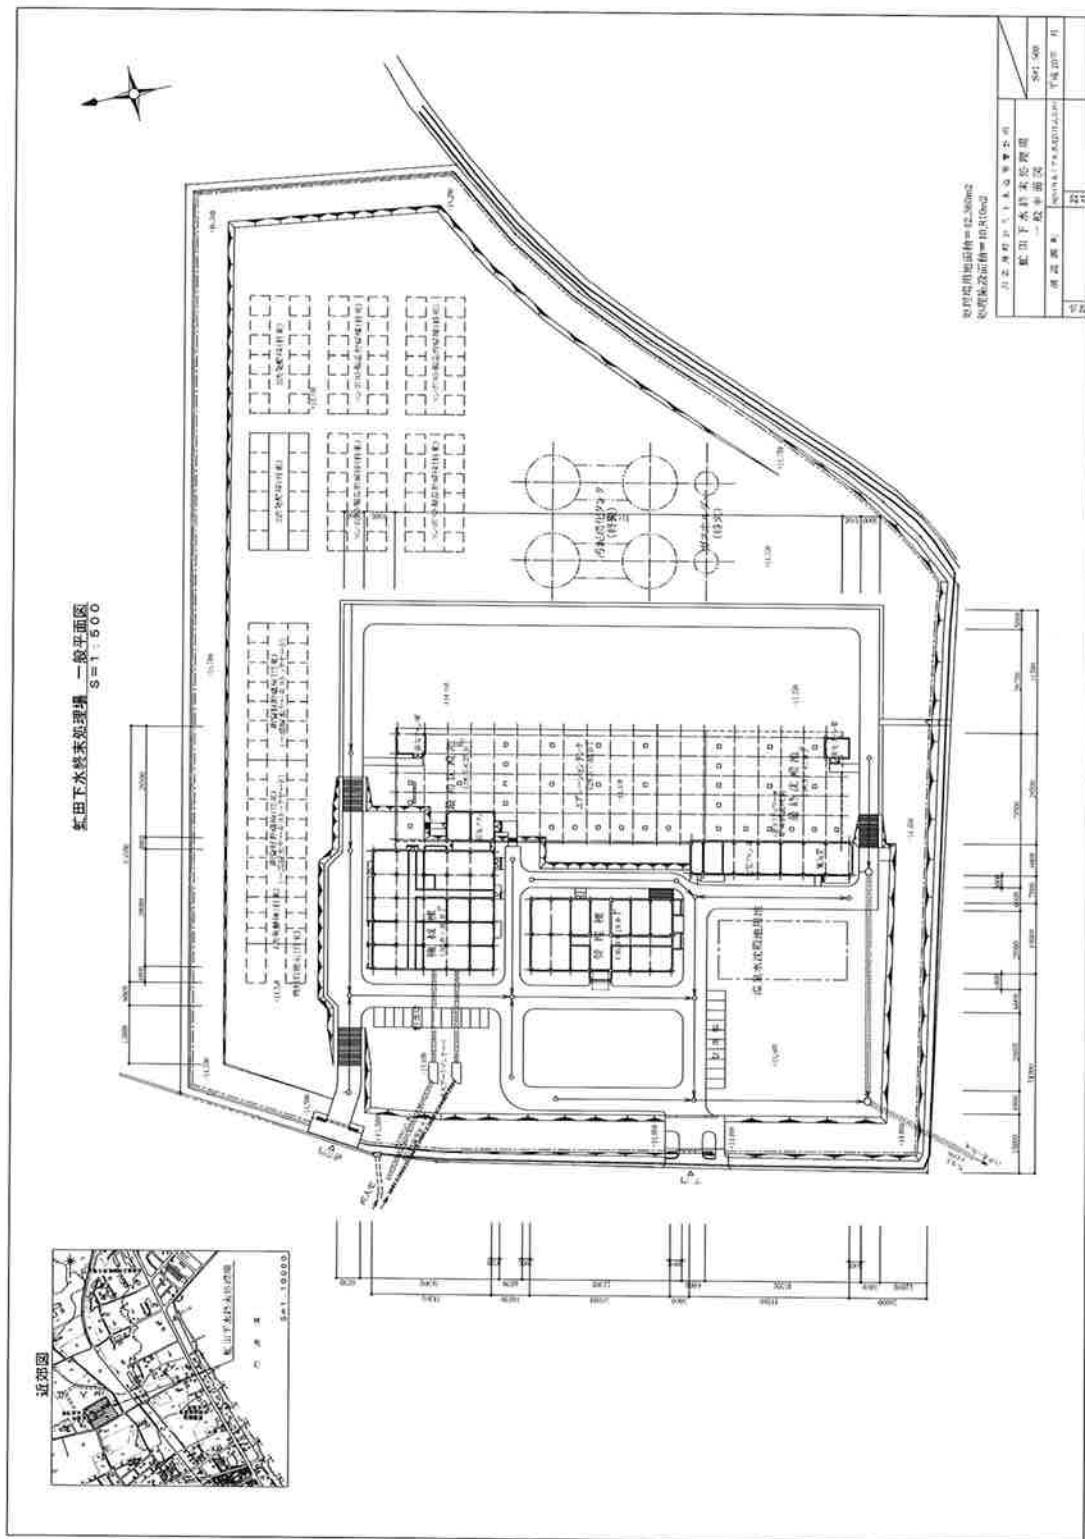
虹田下水終末処理場 一般平面図 (Non-scale)
